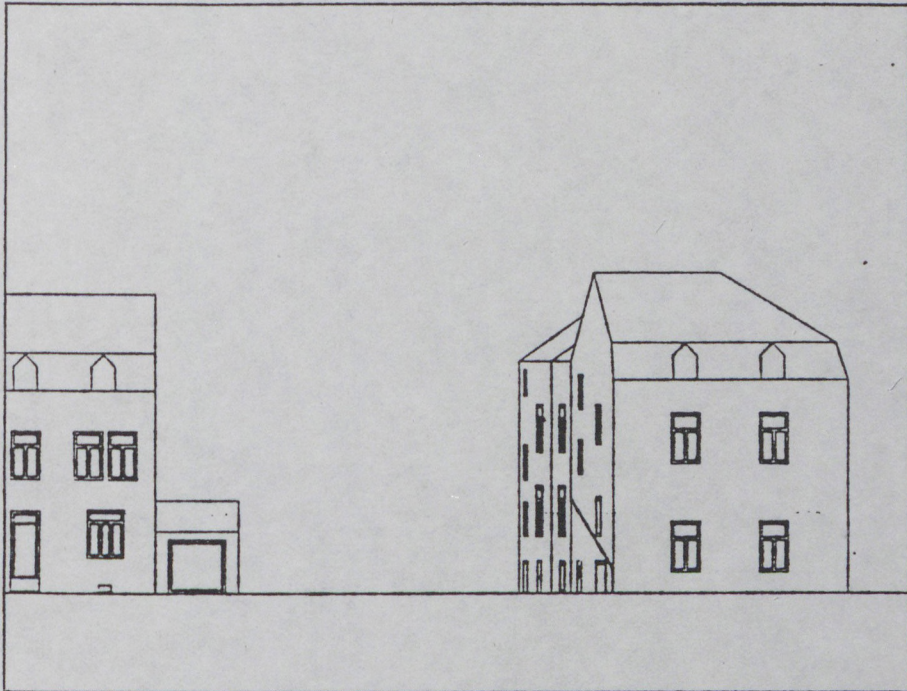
a. : Façade de la rue de la Gendarmerie : situation existante
